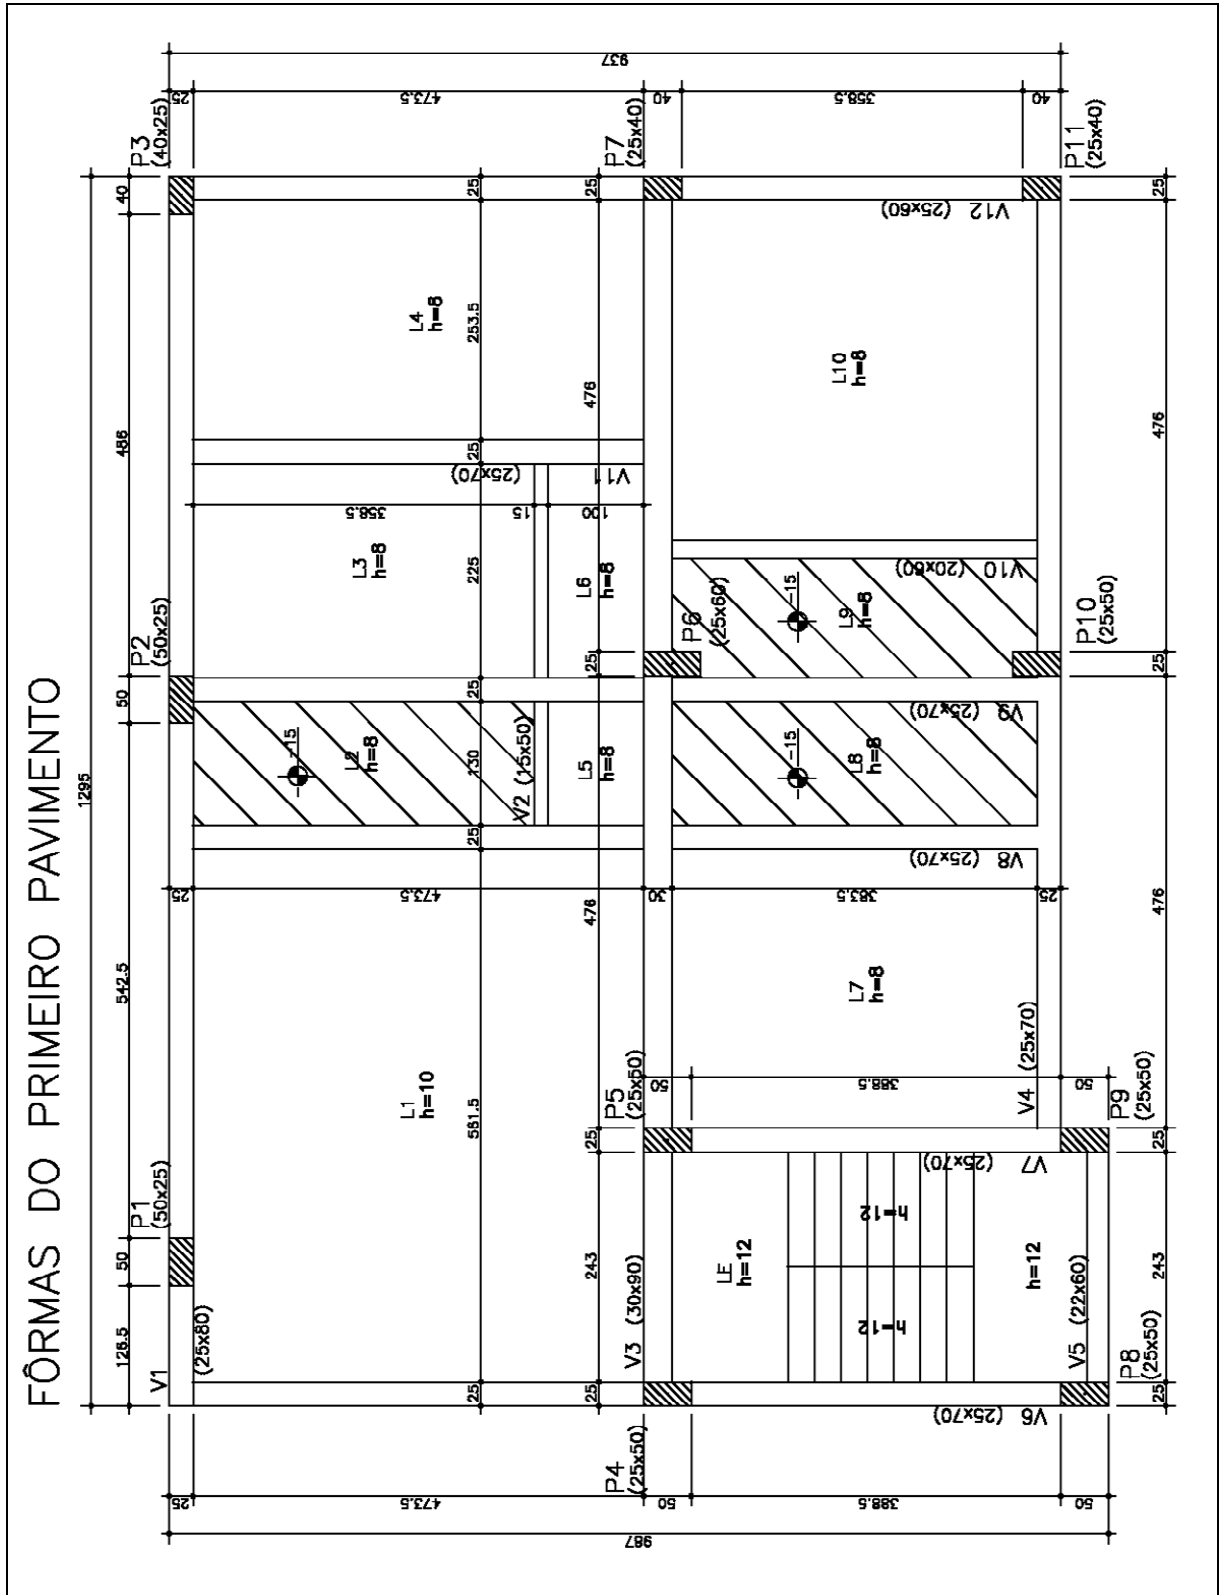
fôrmas do primeiro pavimento (geometria dos elementos)
